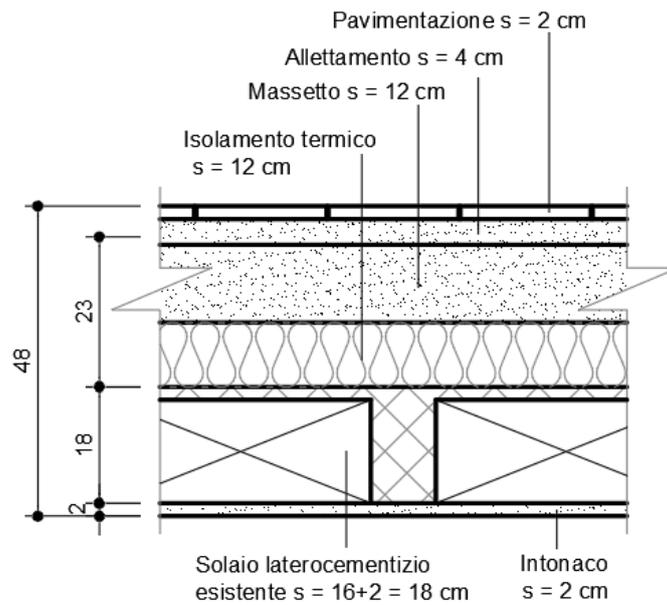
Stratigrafia solaio di progetto con struttura portante esistente.
